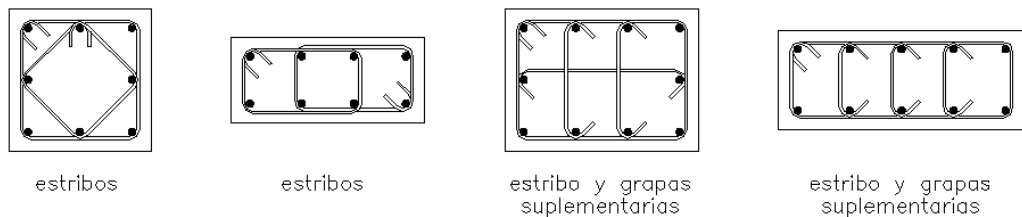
Ejemplos de configuraciones de los estribos de confinamiento.
